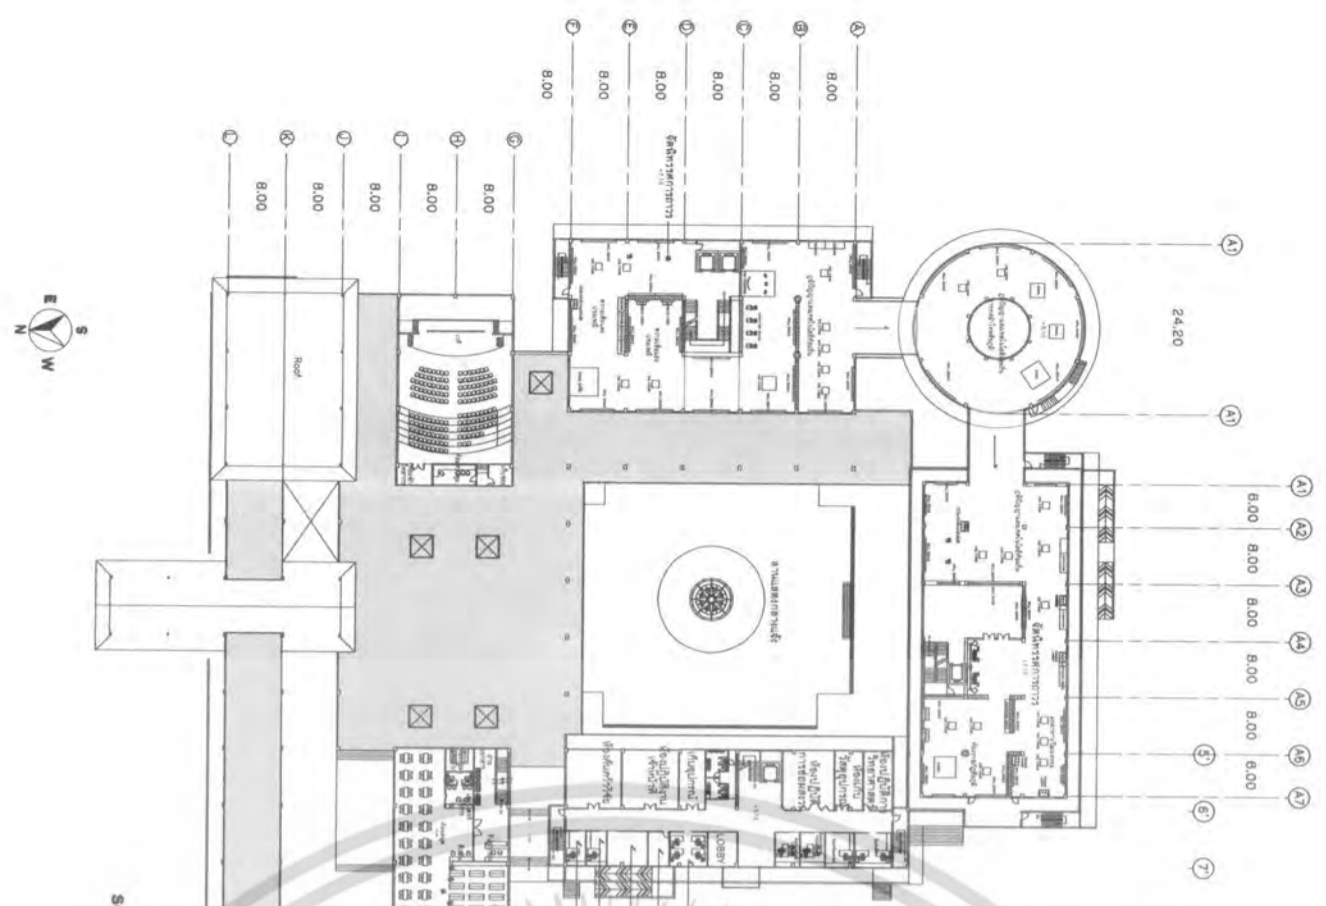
แสดงภาพ Ground floor plan
